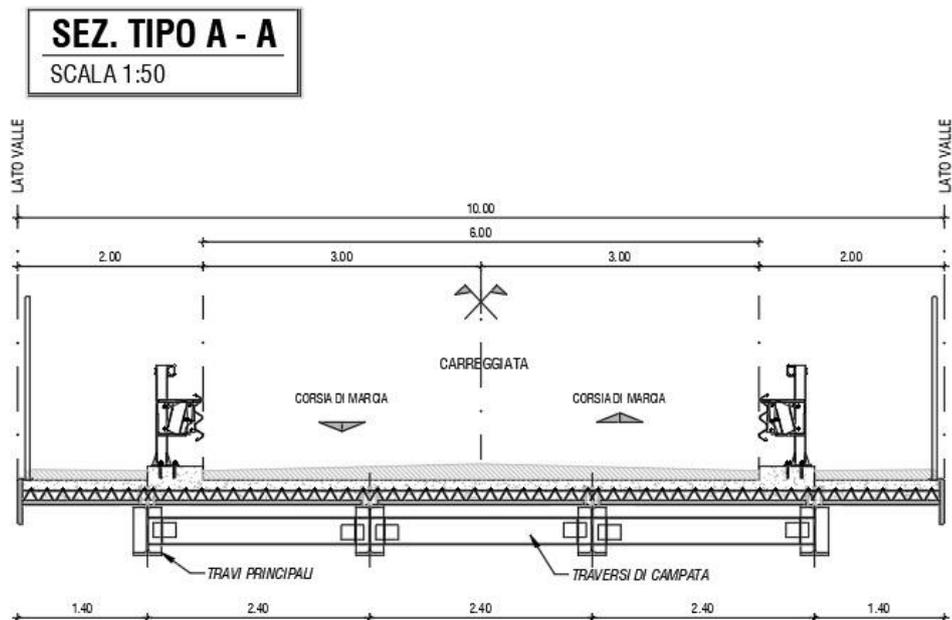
Sezione trasversale Ponte 02- su Canal Magro Via delle Gorine
